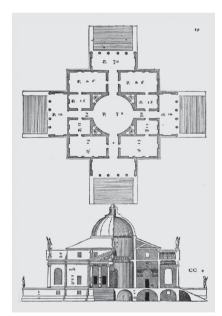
帕拉第奥, 圆厅别野的平面图和立面图
